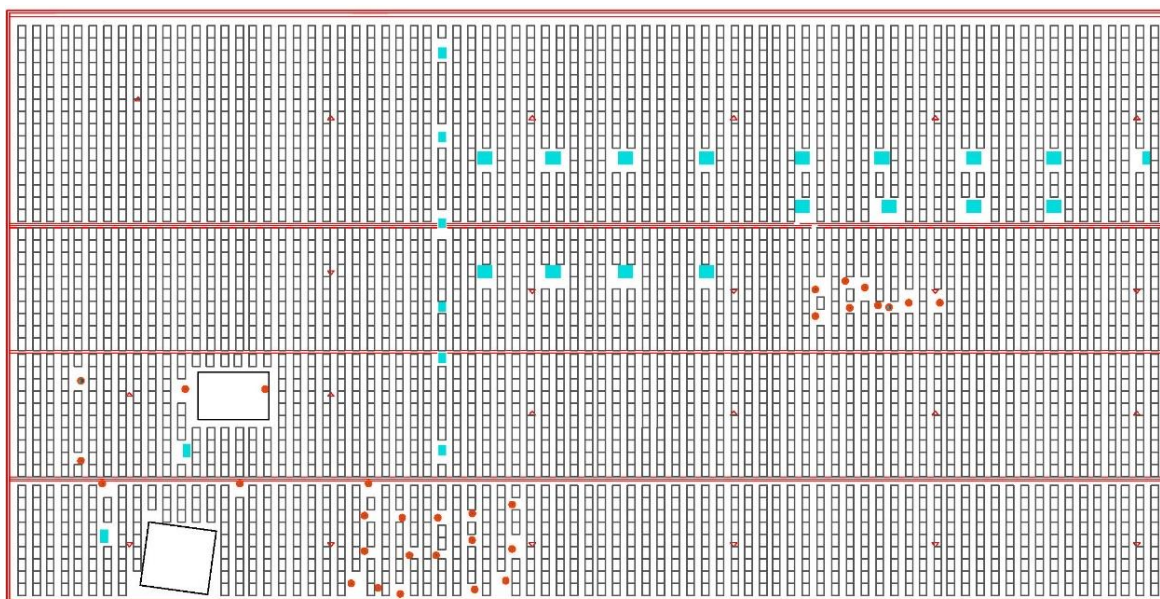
Disposição de 3392 painéis na vertical com 1 metro entre fileiras
